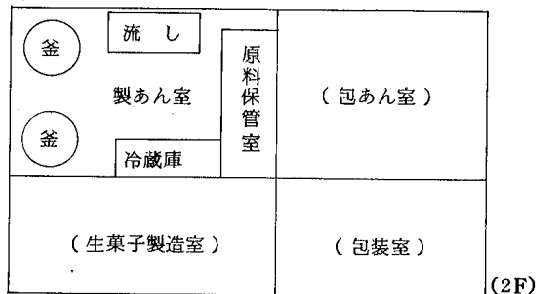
B施設の平面図 延面積 330㎡ 従業員数 20名
